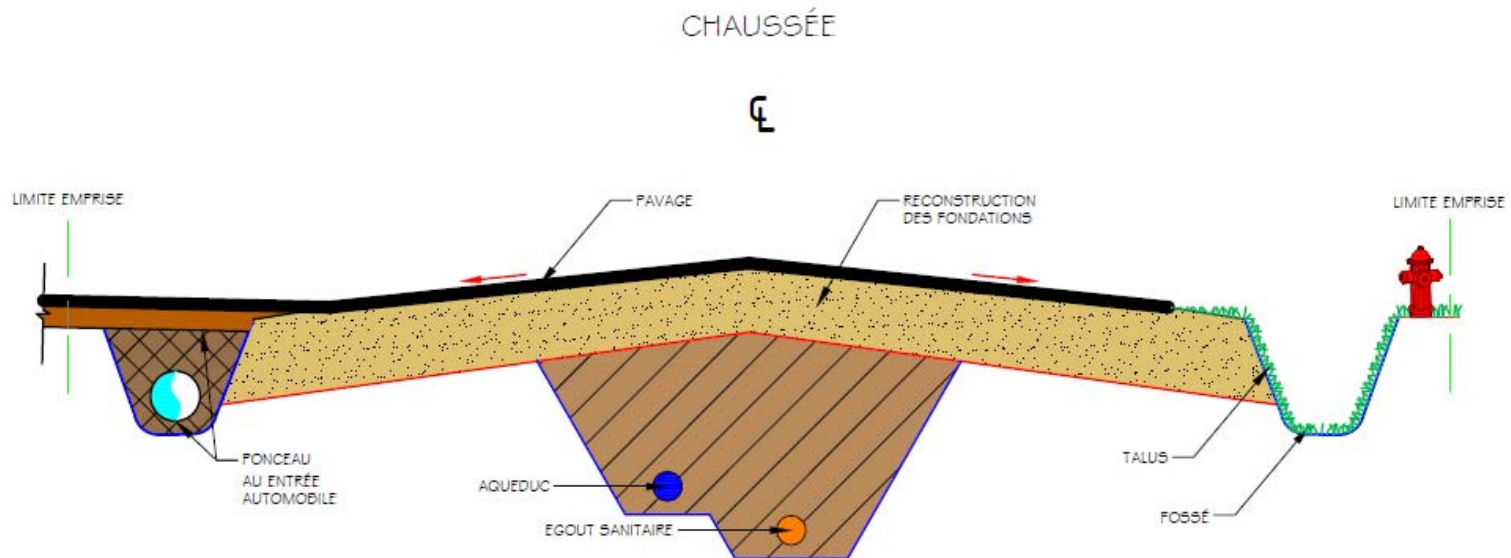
FIGURE: RECONSTRUCTION DE LA CHAUSSÉE AVEC AQUEDUC ET EGOUT DOMESTIQUE
